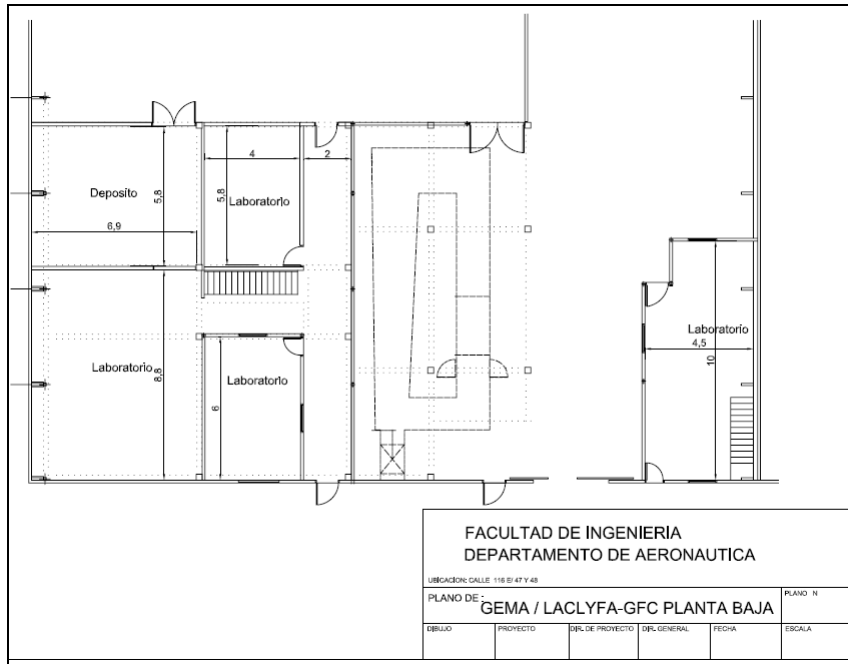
Plano de la planta baja del Edificio (LACLYFA- GFC – GEMA) en obra
